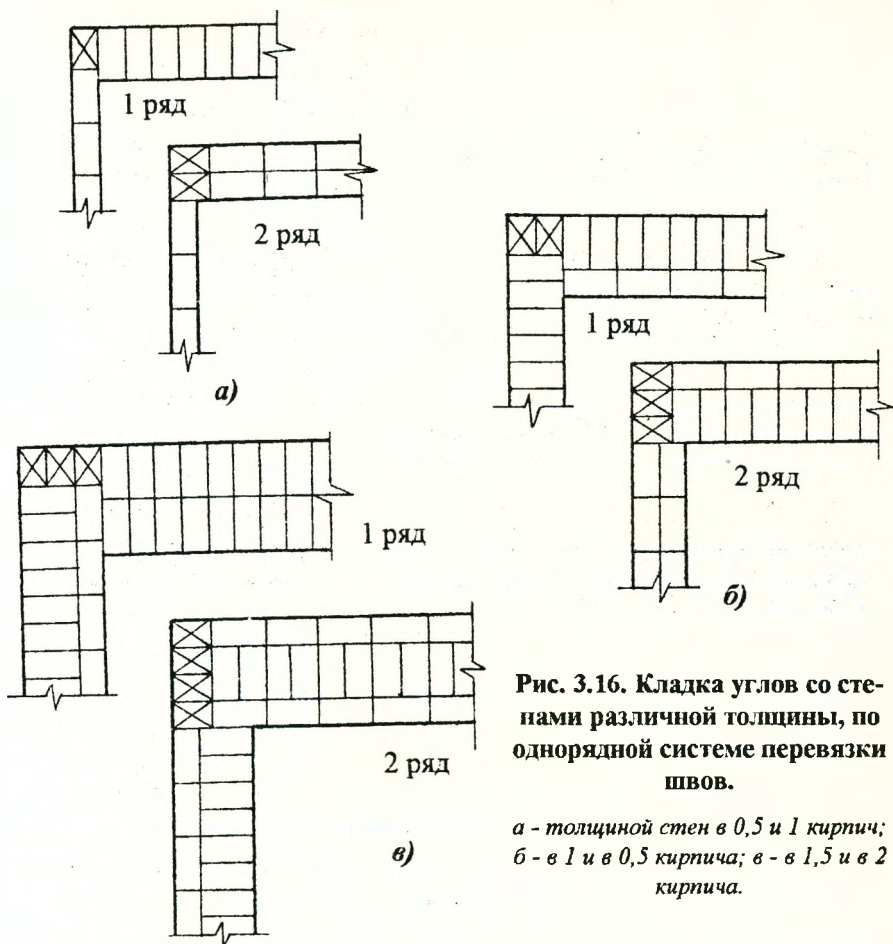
Кладка углов со стенами различной толщины, по однорядной системе перевязки швов.
